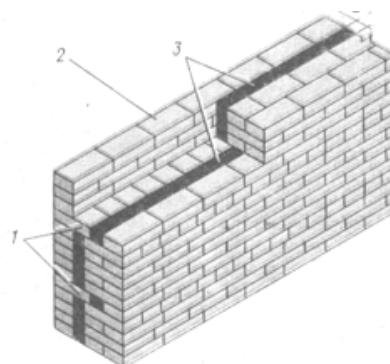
Кладка с утеплителем из теплоизоляционных плит:
